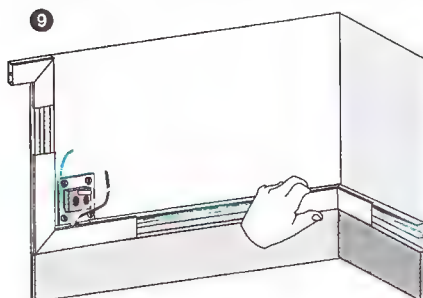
Установка коробов без дополнительных элементов (аксессуаров)
